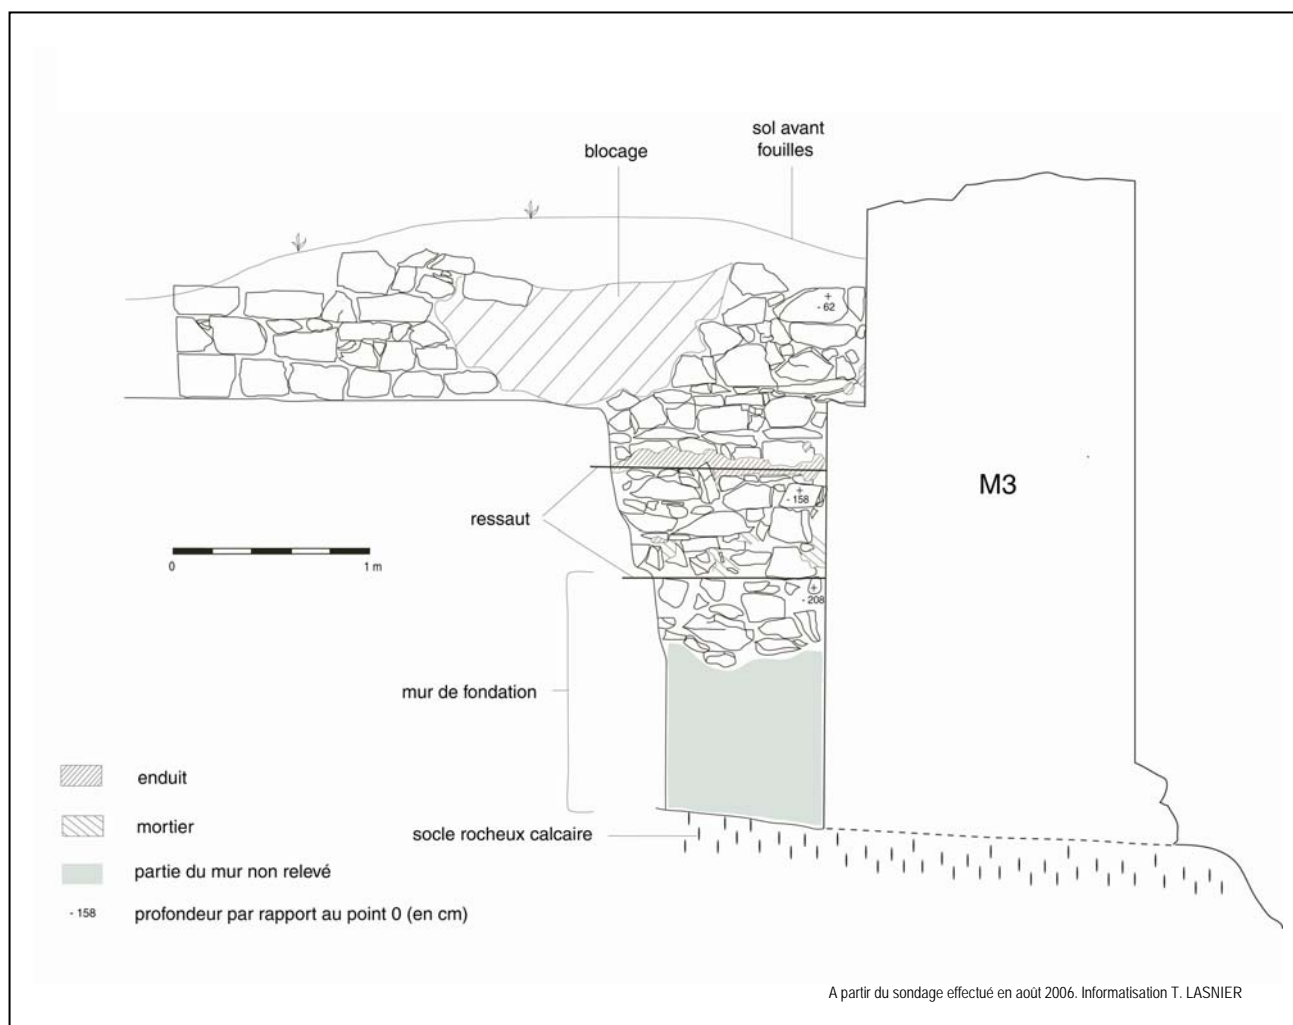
Mirabat : parement externe M2 (sondage 2006, dégagement de bâti zone 1).
